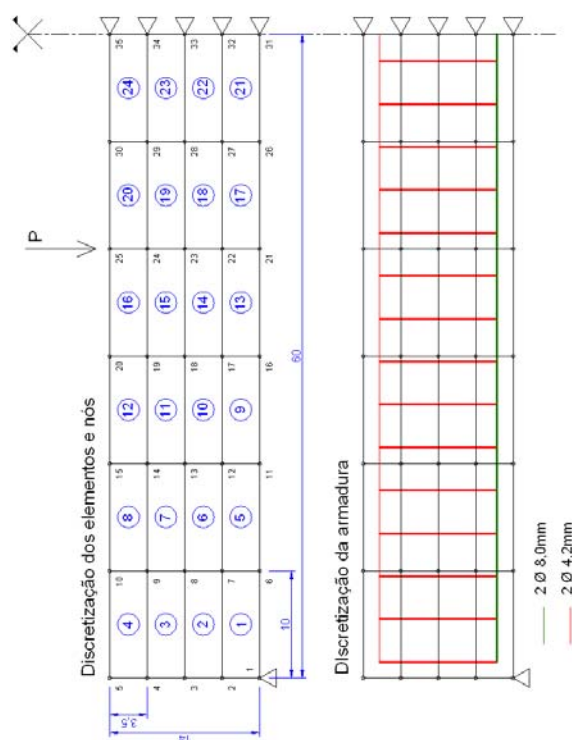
Discretização da malha de elementos finitos e da armadura.
